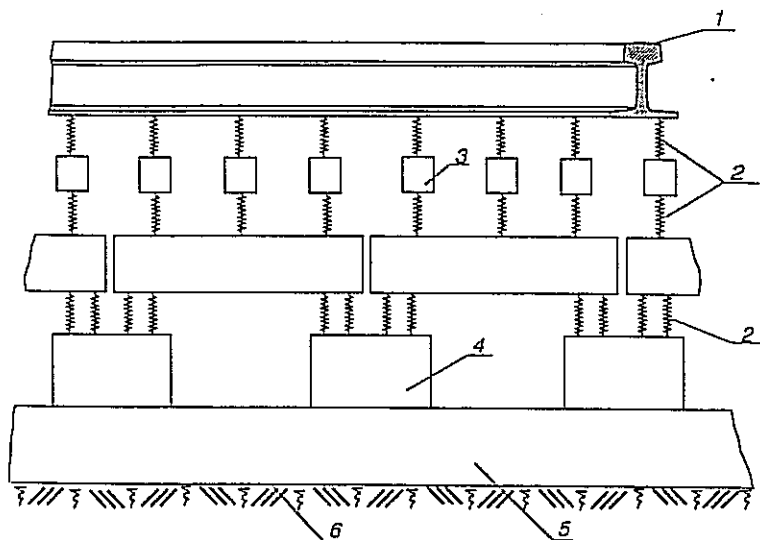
а - рельс; 2 - упругая подкладка; 3 - упругое опирание; 4 - подрельсовая конструкция; 5 - основная несущая конструкция; 6 - усиленное основание; 7 - земляное полотно.
